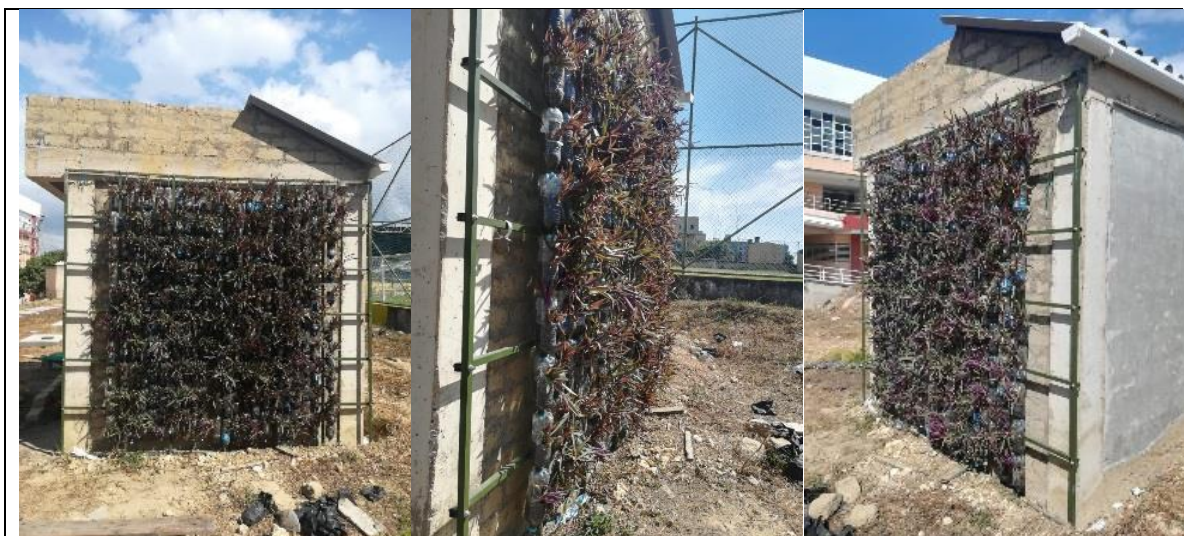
Muro verde con Barquillo morado, ubicado en la fachada Oeste.
